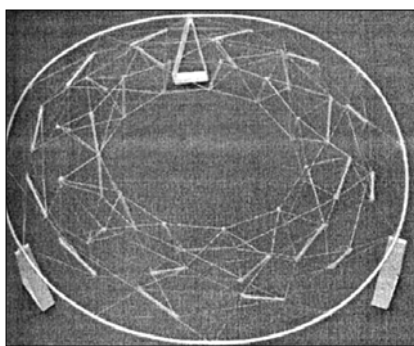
Widok wewnętrzny konstrukcji dachu hali Atlanata Dome – widoczne: pierścień głównej linii napinającej, linii promieniowe i słupki rozpierające
